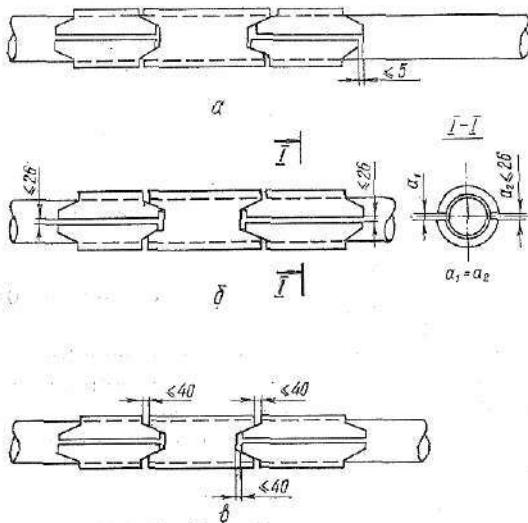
Балластировка трубопроводов из сборного железобетона:
